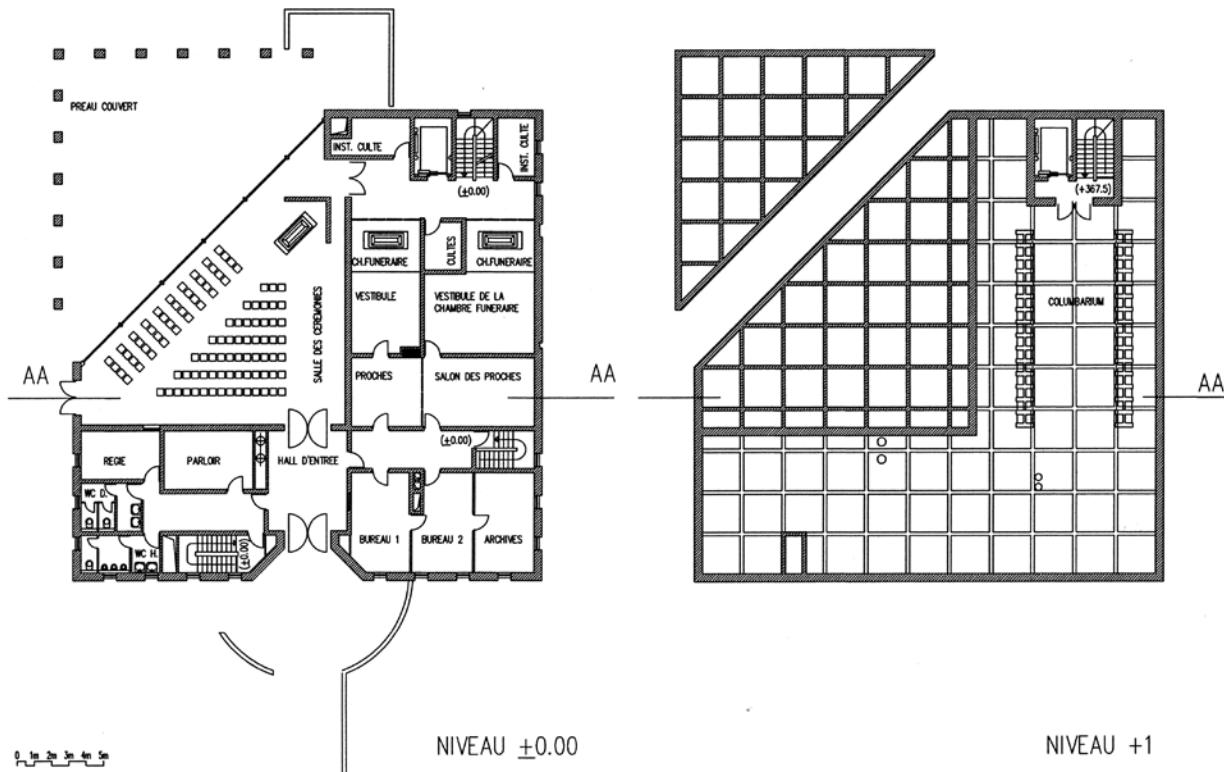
Krematorium Luxemburg-Hamm, Entwurf von Perry Weber, Grundrisse Erd- und Dachgeschoss. Privatarchiv Perry Weber.
